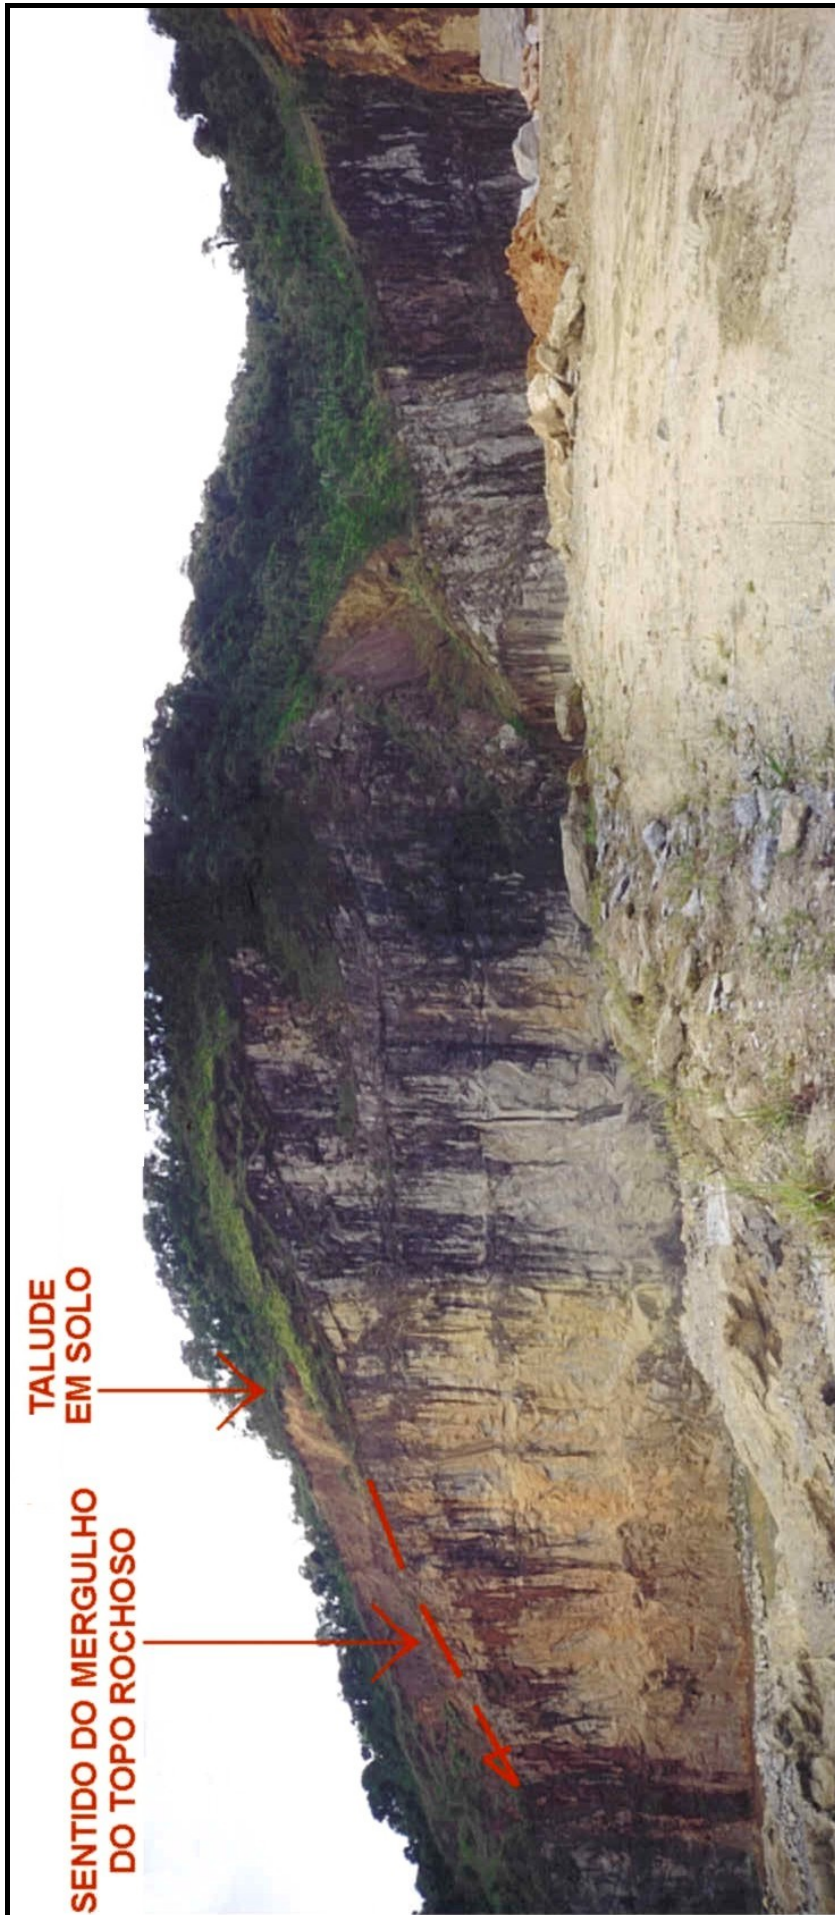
Vista Geral do setor NW-W-SW
